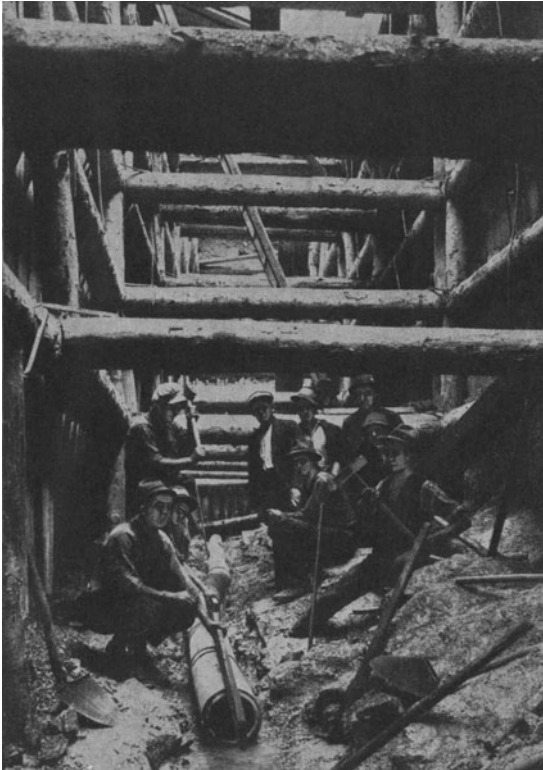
Ableitung des Wassers gegen den Pumpensumpf in Betonrohren.
